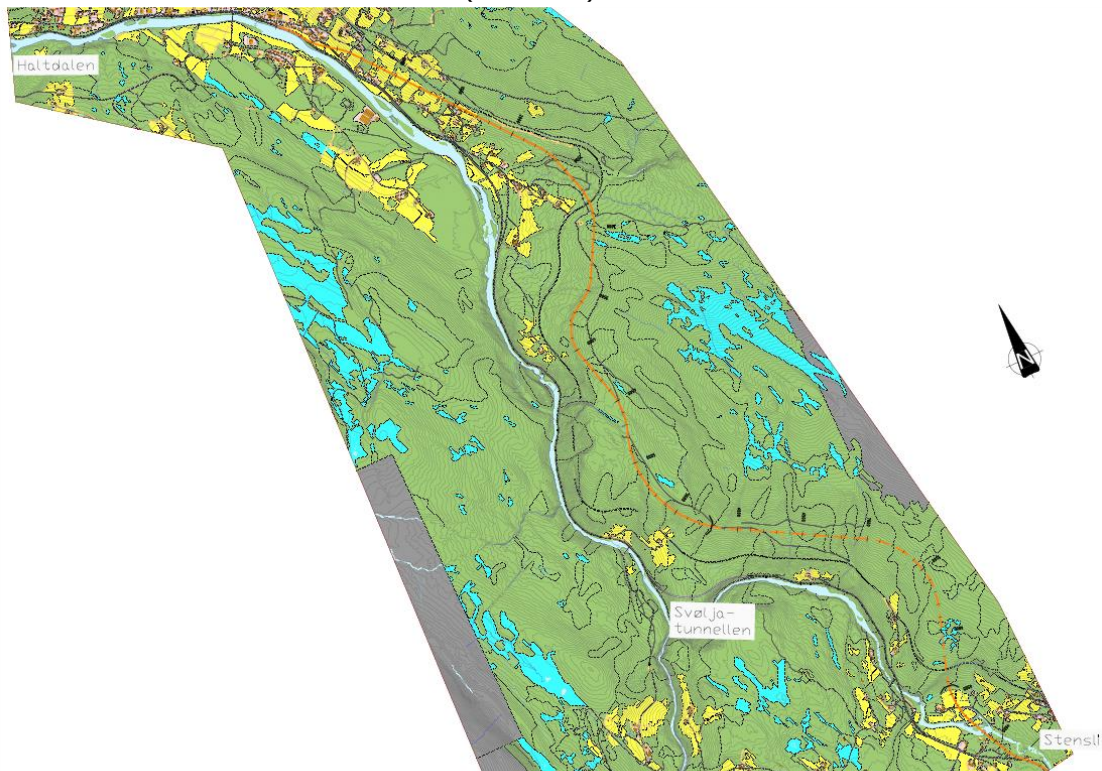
Alt 7: Tunnel (1,2 km) på østsiden
